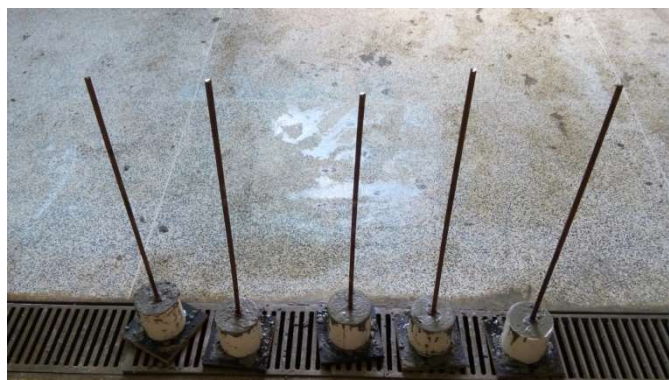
Corpo de prova concretados para ensaio de arrancamento
